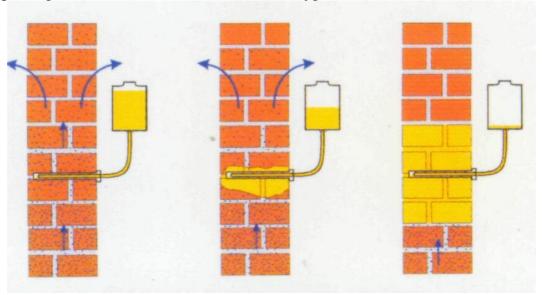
Инъекционная пропитка кирпичных стен для создания горизонтальной гидроизоляции
